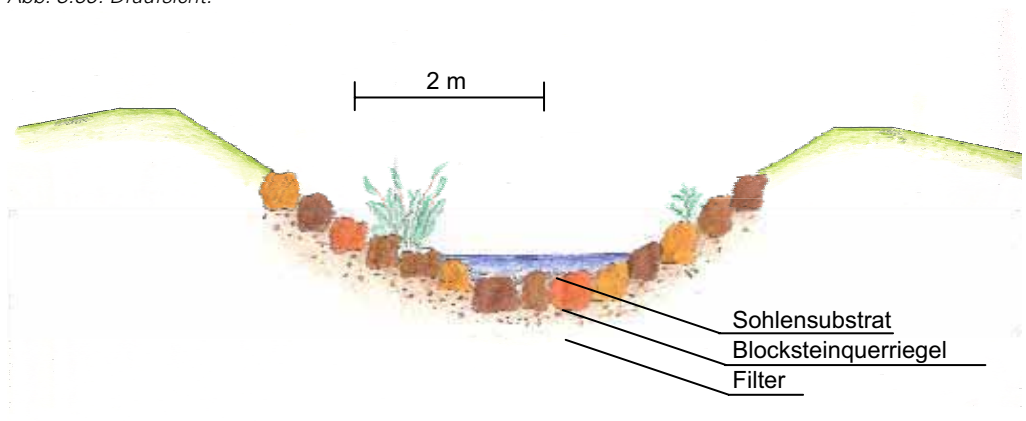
Regelquerschnitt des Umgebungswässers.
